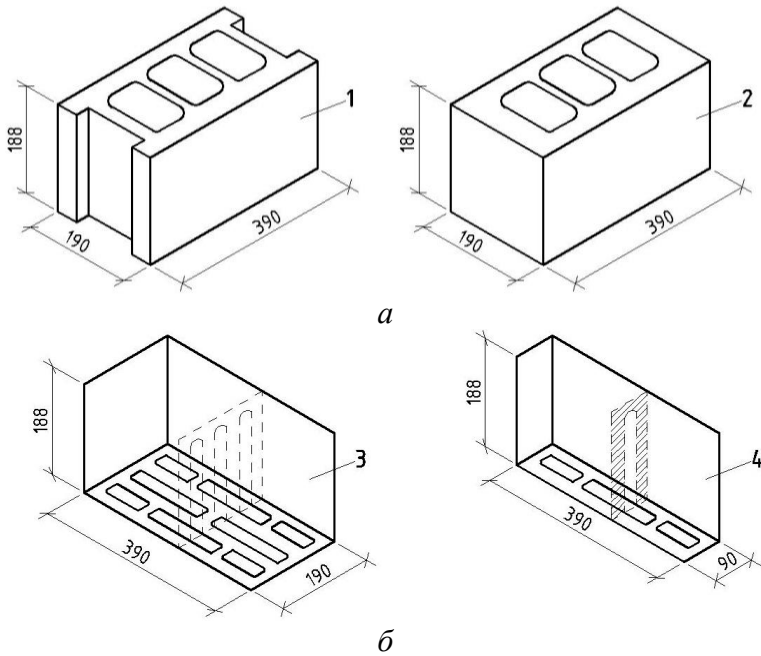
Каміні бетонні порожнисті: *а* – з трьома порожнинами;
